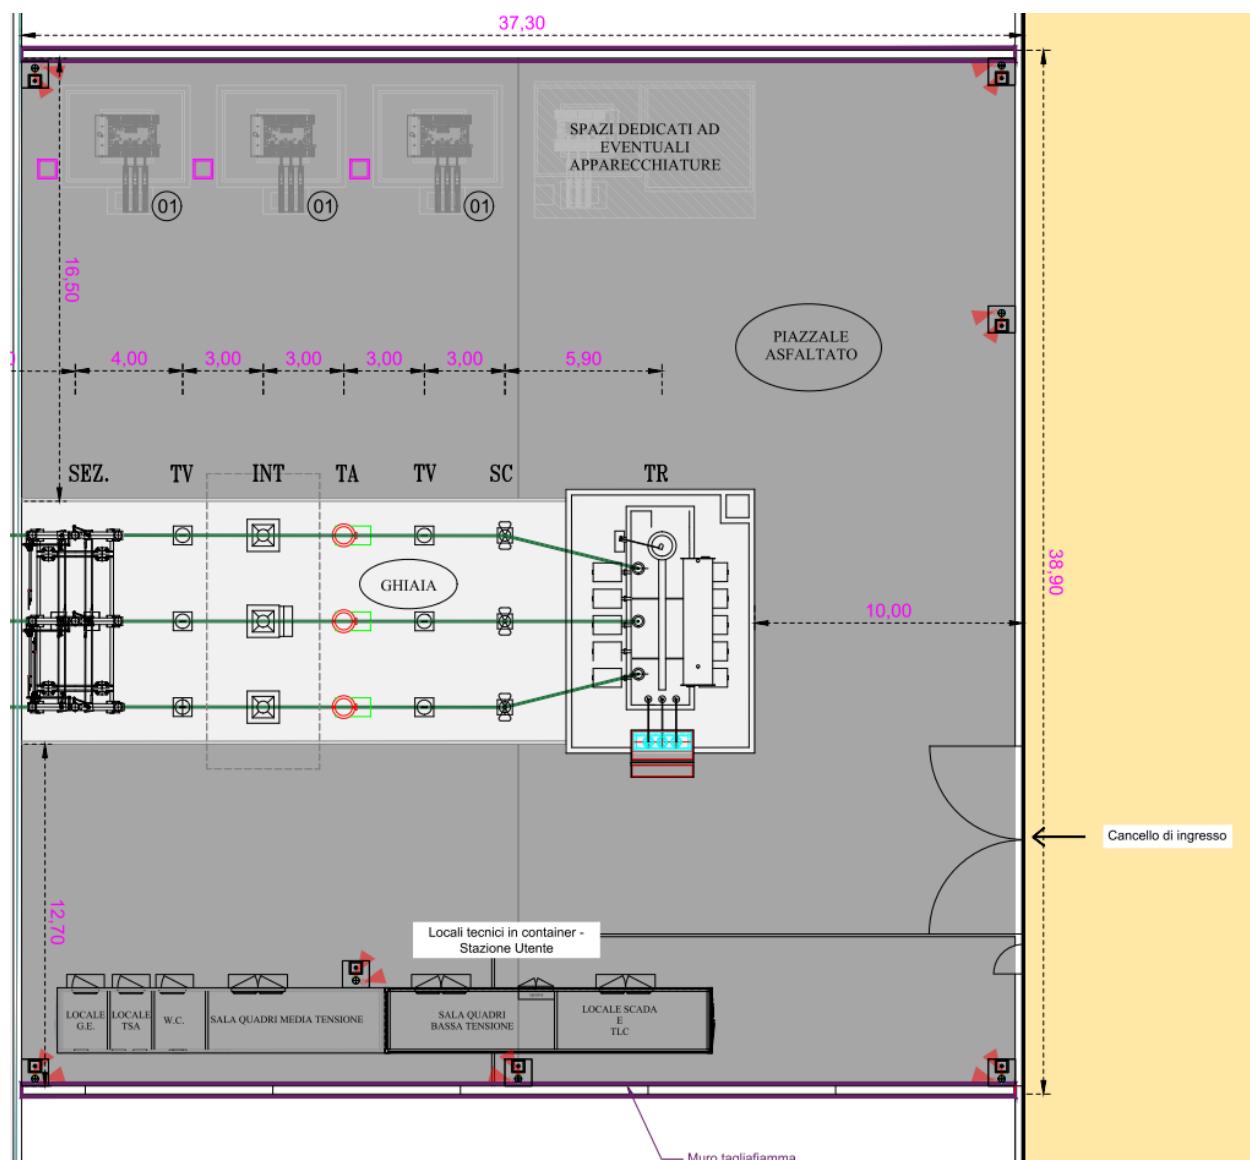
Planimetria elettromeccanica stazione utente 220/30 kV
